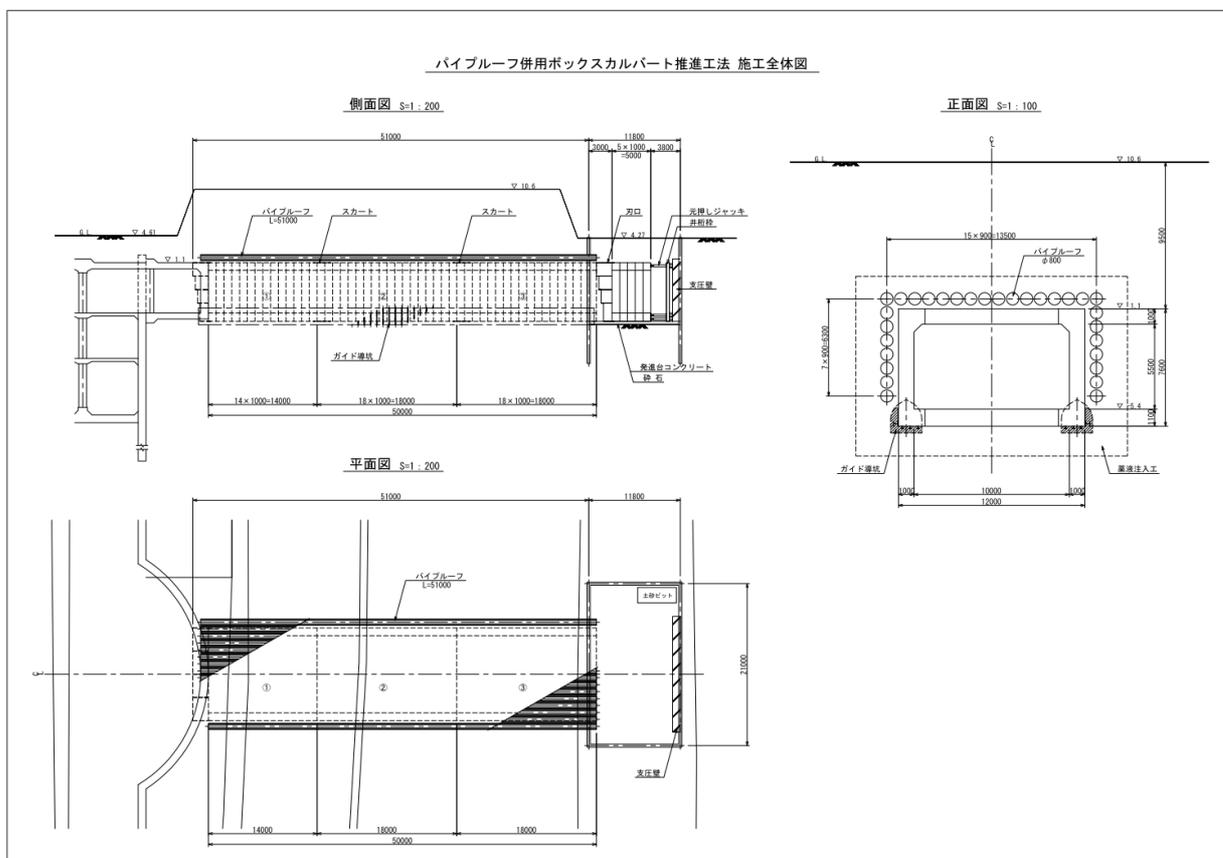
パイプルーフ併用ボックスカルバート推進工法施工図
